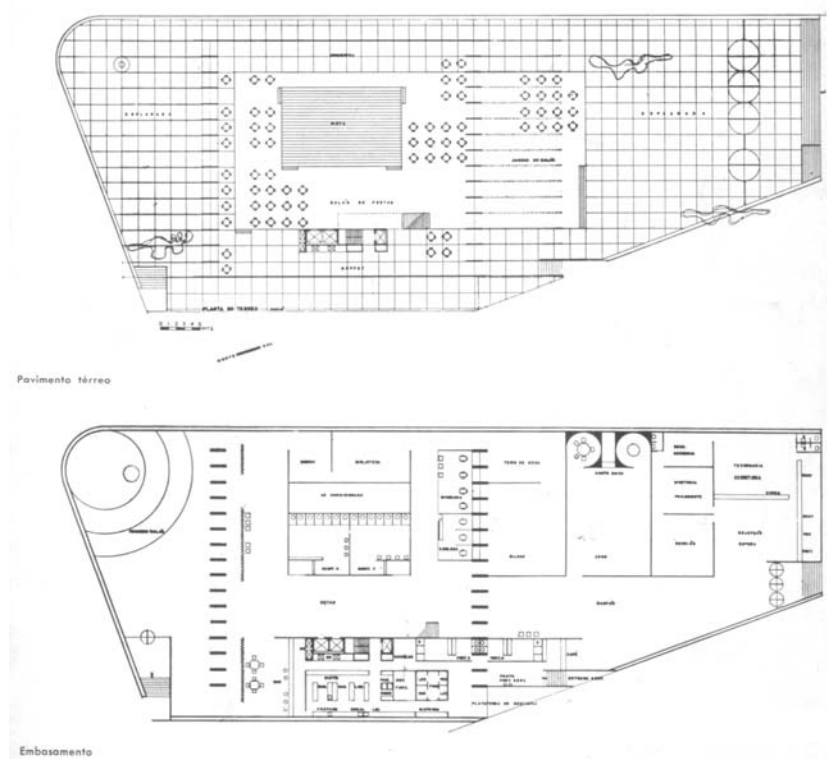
(acima): Plantas do embasamento (abaixo) e do pavimento térreo (acima) do Clube XV. Fonte: Revista Acrópole nº 294, p. 169.
